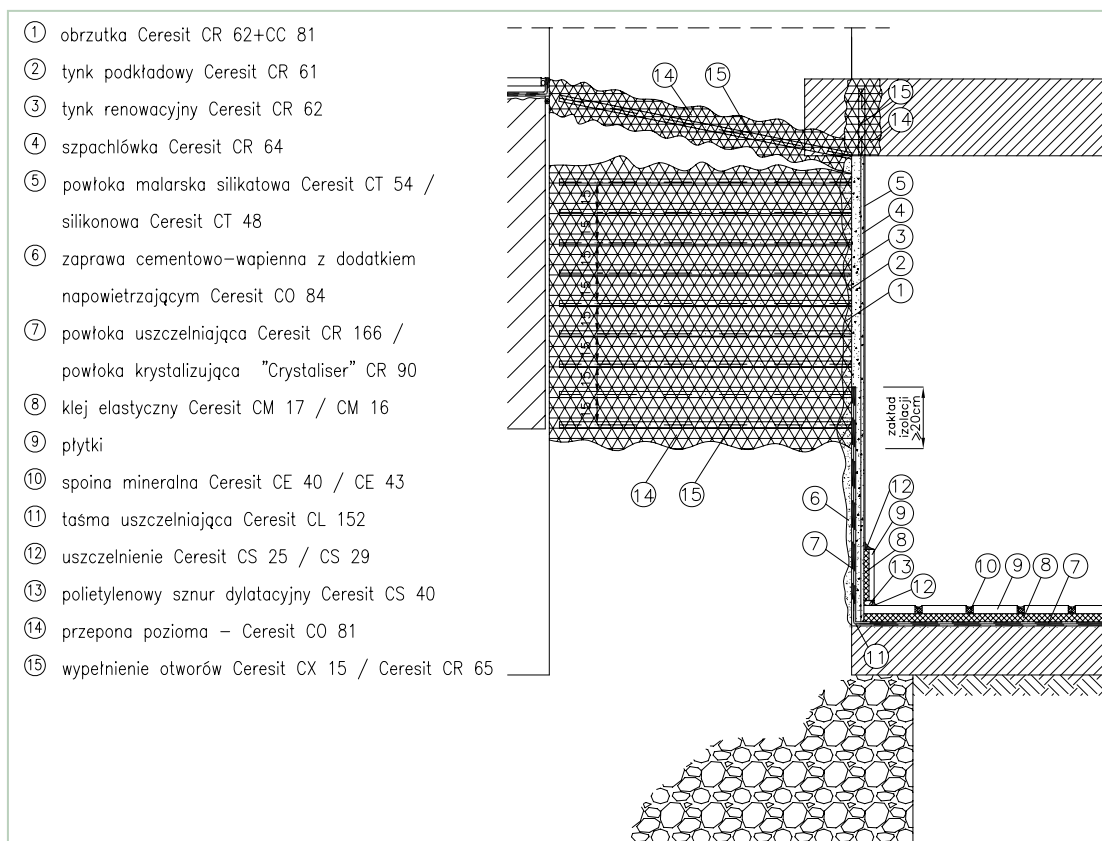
Tynkowanie muru tynkiem renowacyjnym z przeponą wykonaną od wewnątrz i zewnętrzną izolacją
